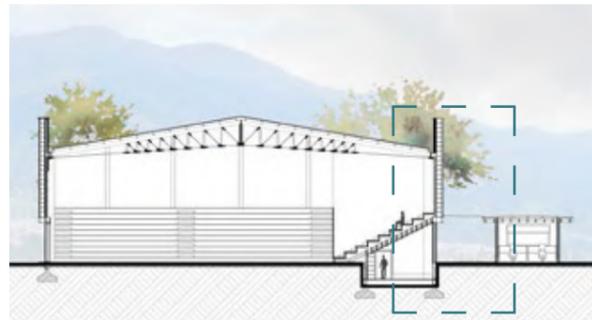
| Sistema constructivo coliseo | Fuente: Elaboración Propia
